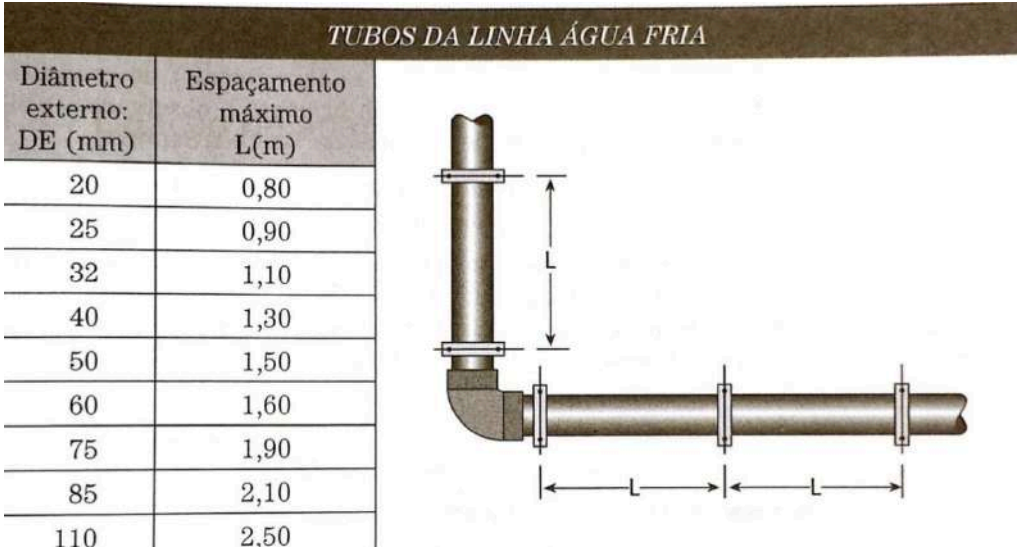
Espaçamento máximo entre apoios conforme diâmetro.
